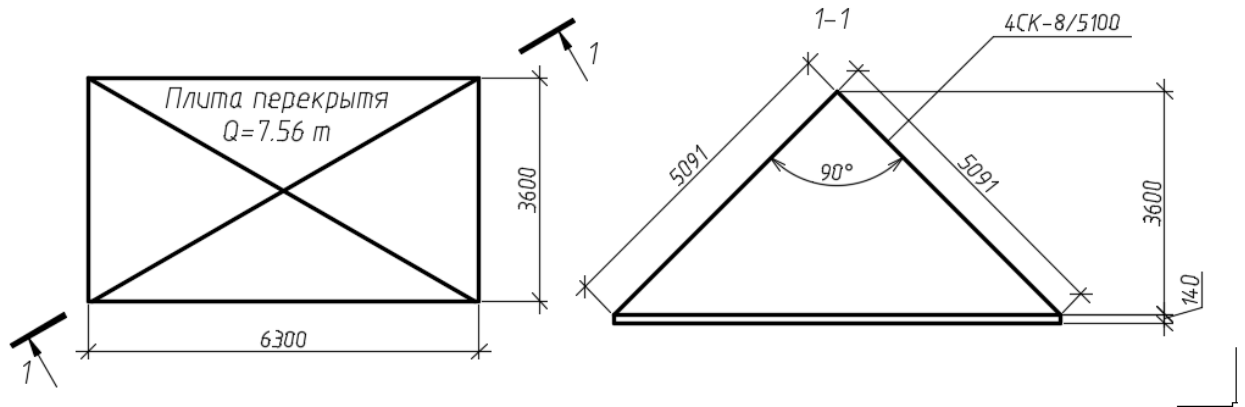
Определение длины стропы для монтажа плиты перекрытия.
